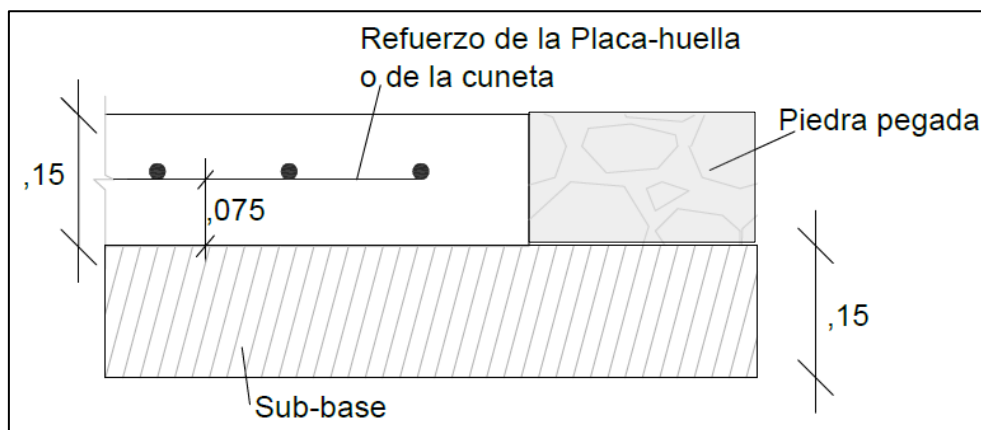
Junta longitudinal entre Placa-huella o Berma-cuneta y la Piedra pegada [3]
